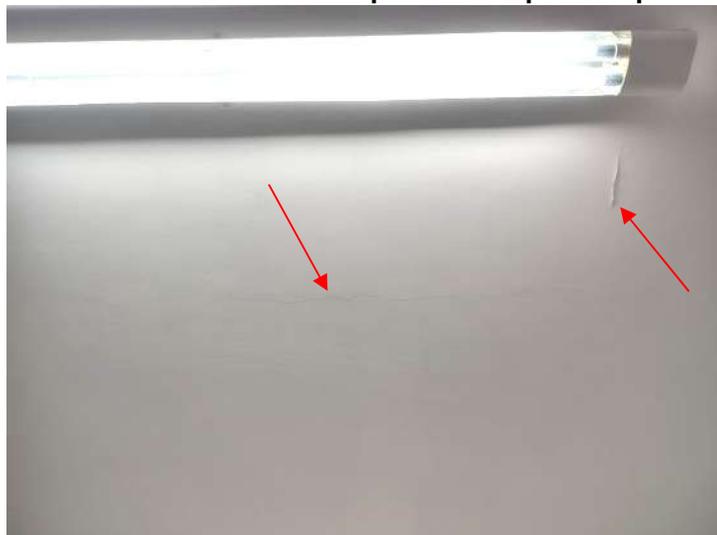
Sala Diretoria – Fissuras no teto
